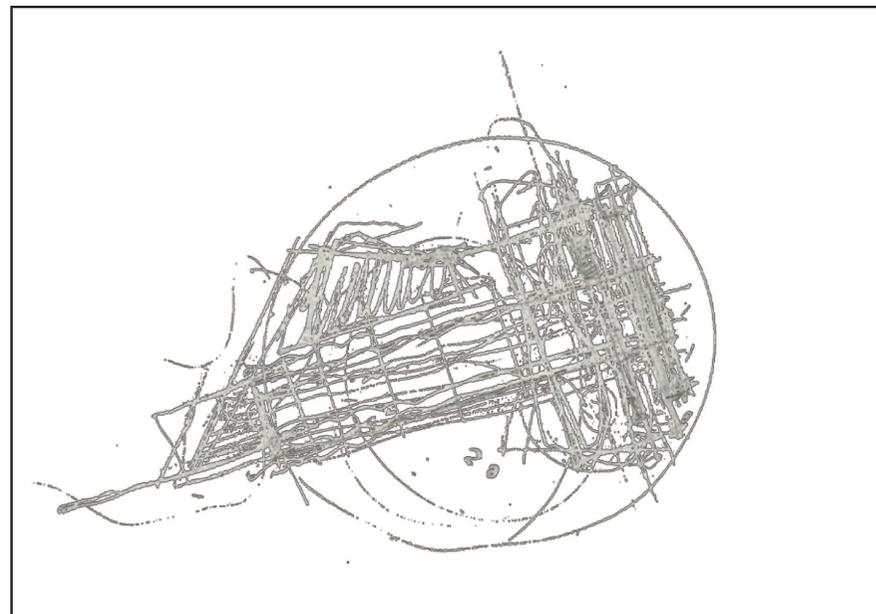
Croqui especulativo em planta realizado pelo Arquiteto Experiente 2.
